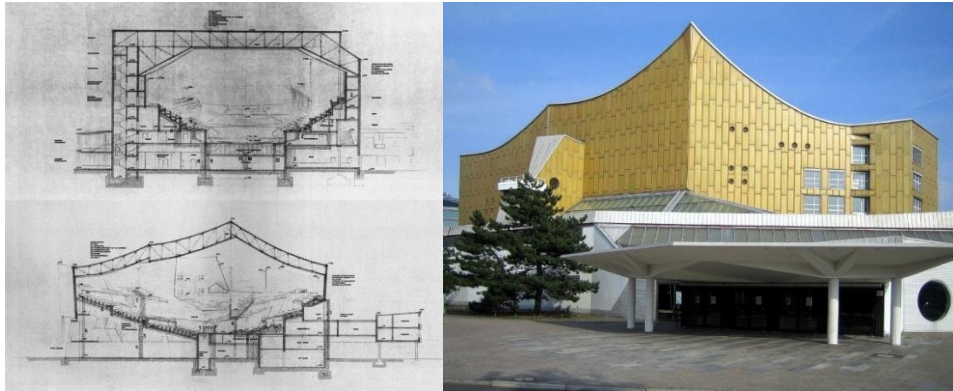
Plano e imagen de la filarmónica de Berlín. Arquitecto: Hans Scharoun
